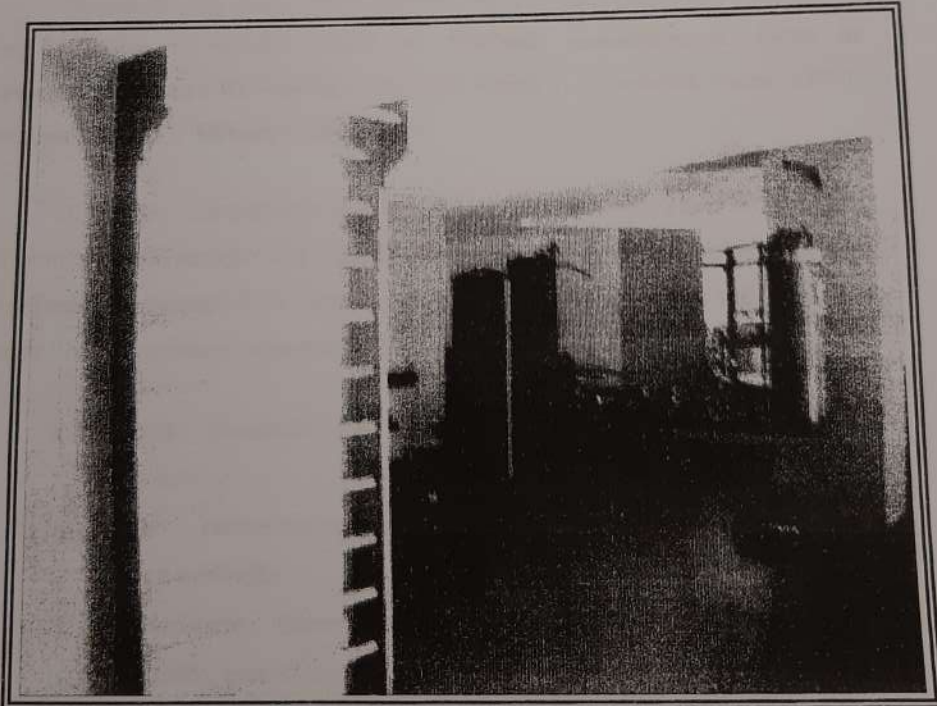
Detalhe da academia do Condomínio Jardins do Morumbi
